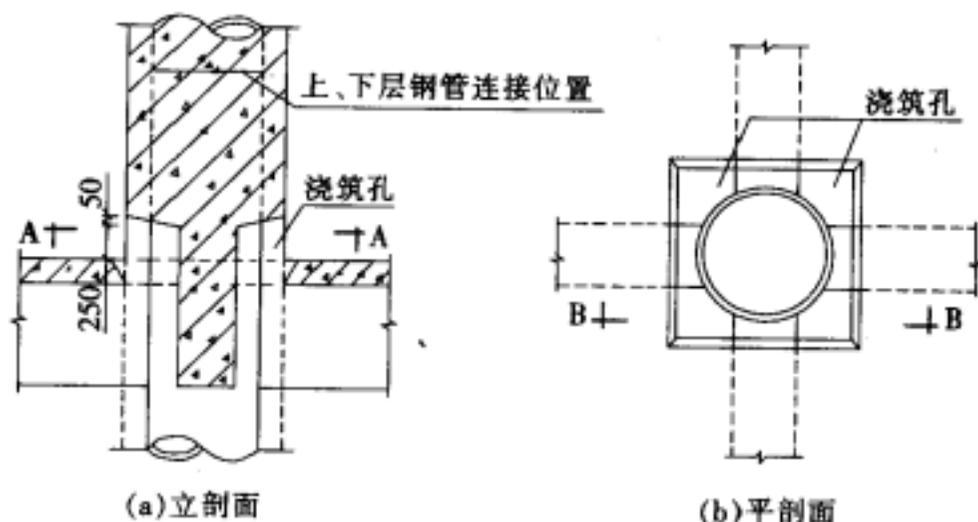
同期施工叠合柱与不同期施工叠合柱连接构造
